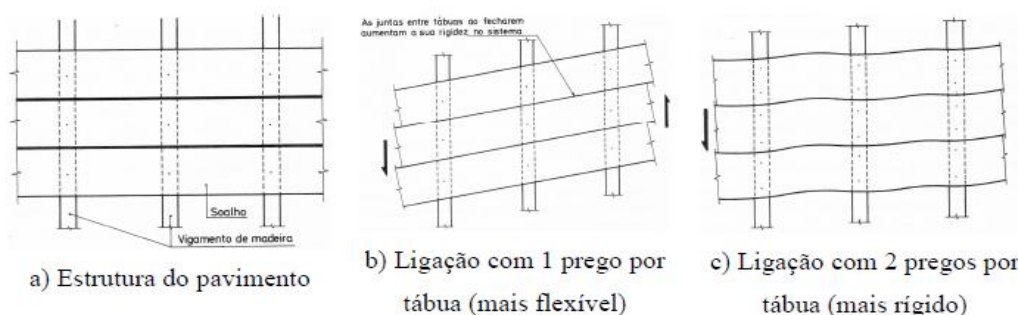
Influência das ligações na rigidez do pavimento.[10]
